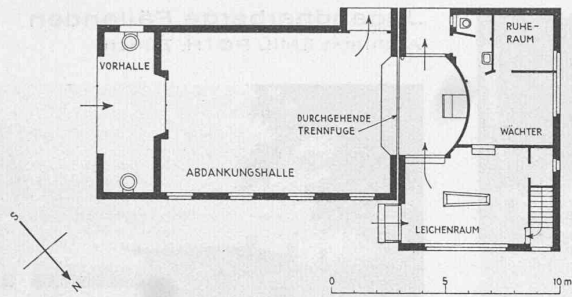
Grundriss des Abdankungs- und Leichenhauses 1 : 300
